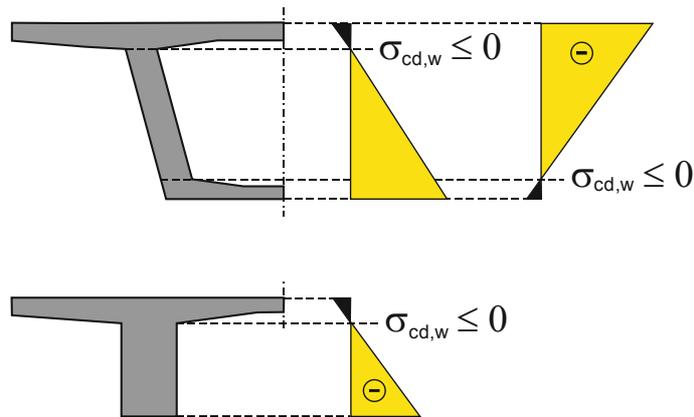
Querschnittsbereiche mit in der Zugzone liegendem Gurt
